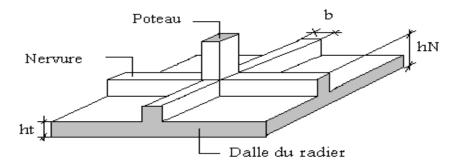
Disposition des nervures par rapport au radier et aux poteaux
